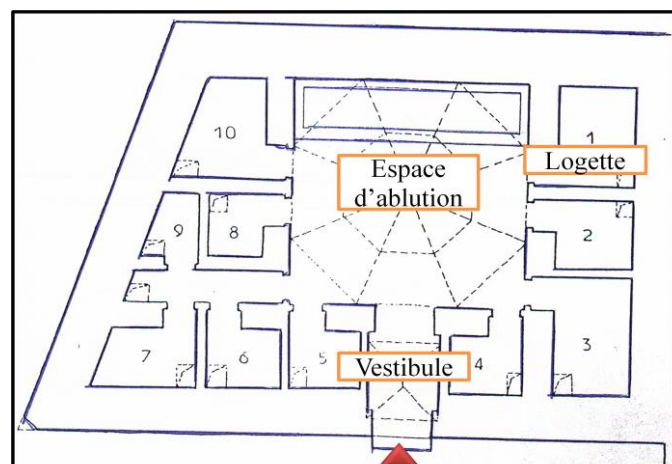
Vue en plan de la salle d'ablution et latrines.
